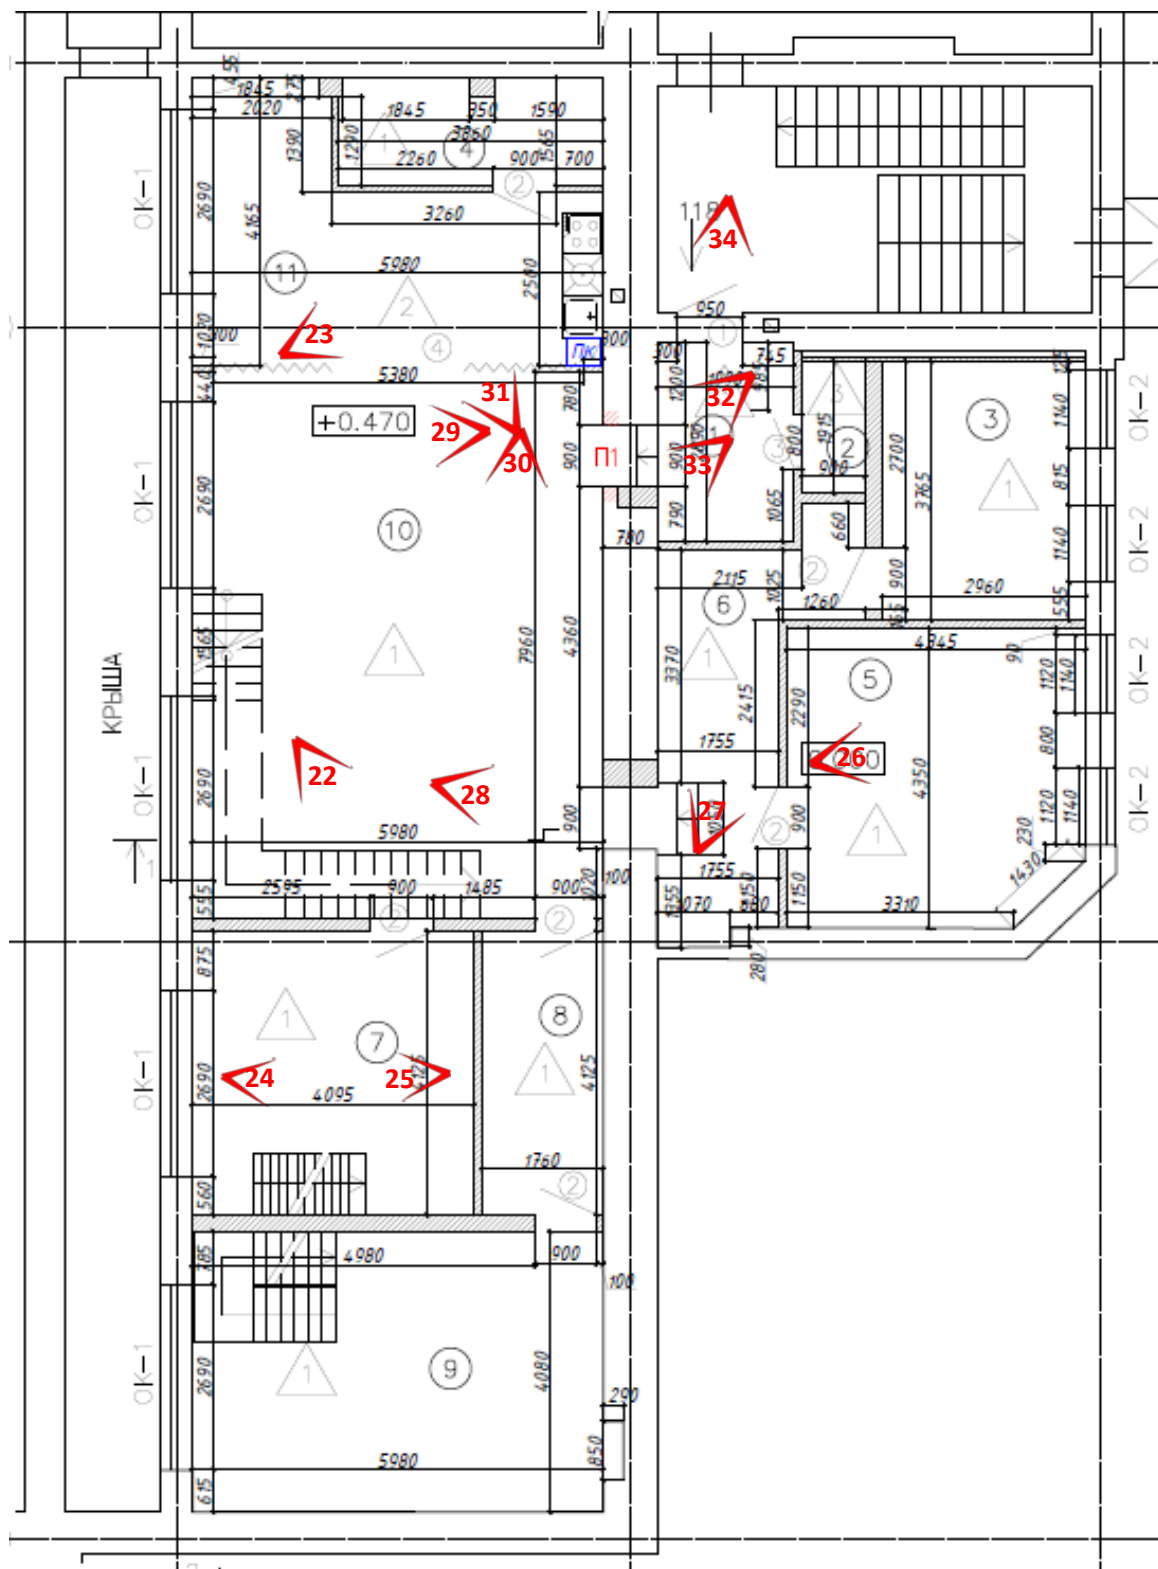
Схема фотофиксации на фрагменте плана 1 этажа
